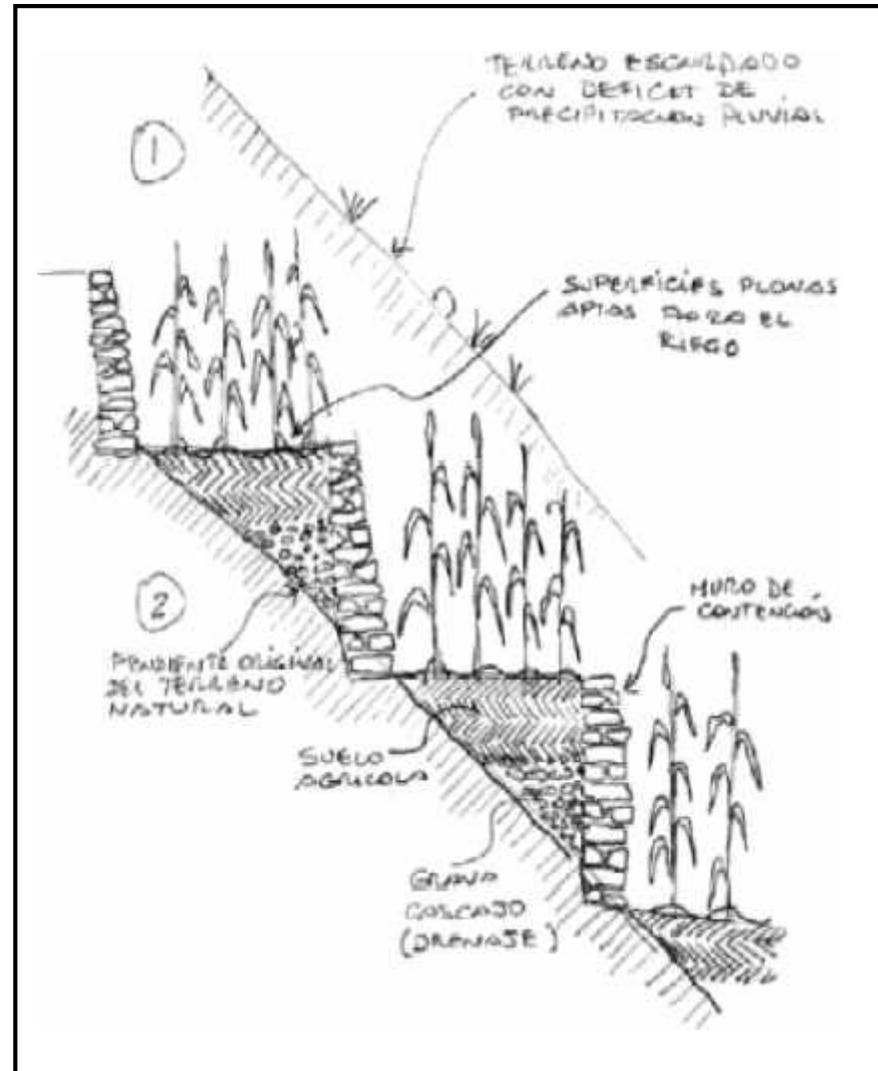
Croquis constructivo de andenes Fuente Paisajes Culturales
